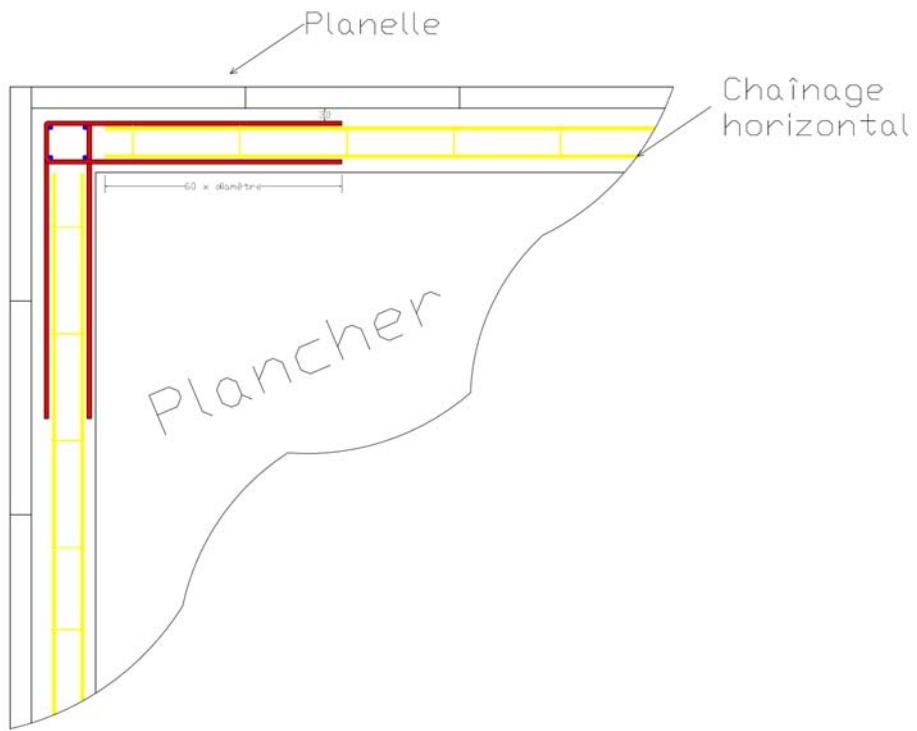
Passage des aciers, coupe verticale – Planelle TP5
